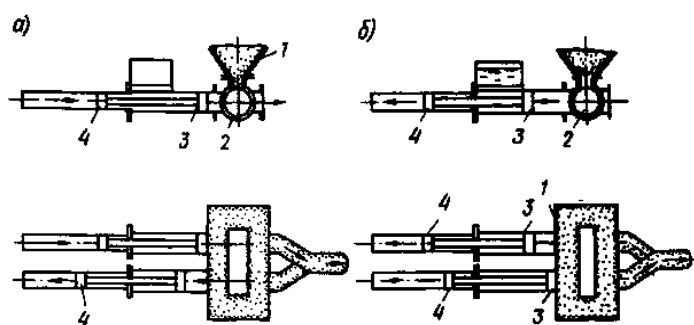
Схема работы бетононасоса с гидравлическим приводом:
